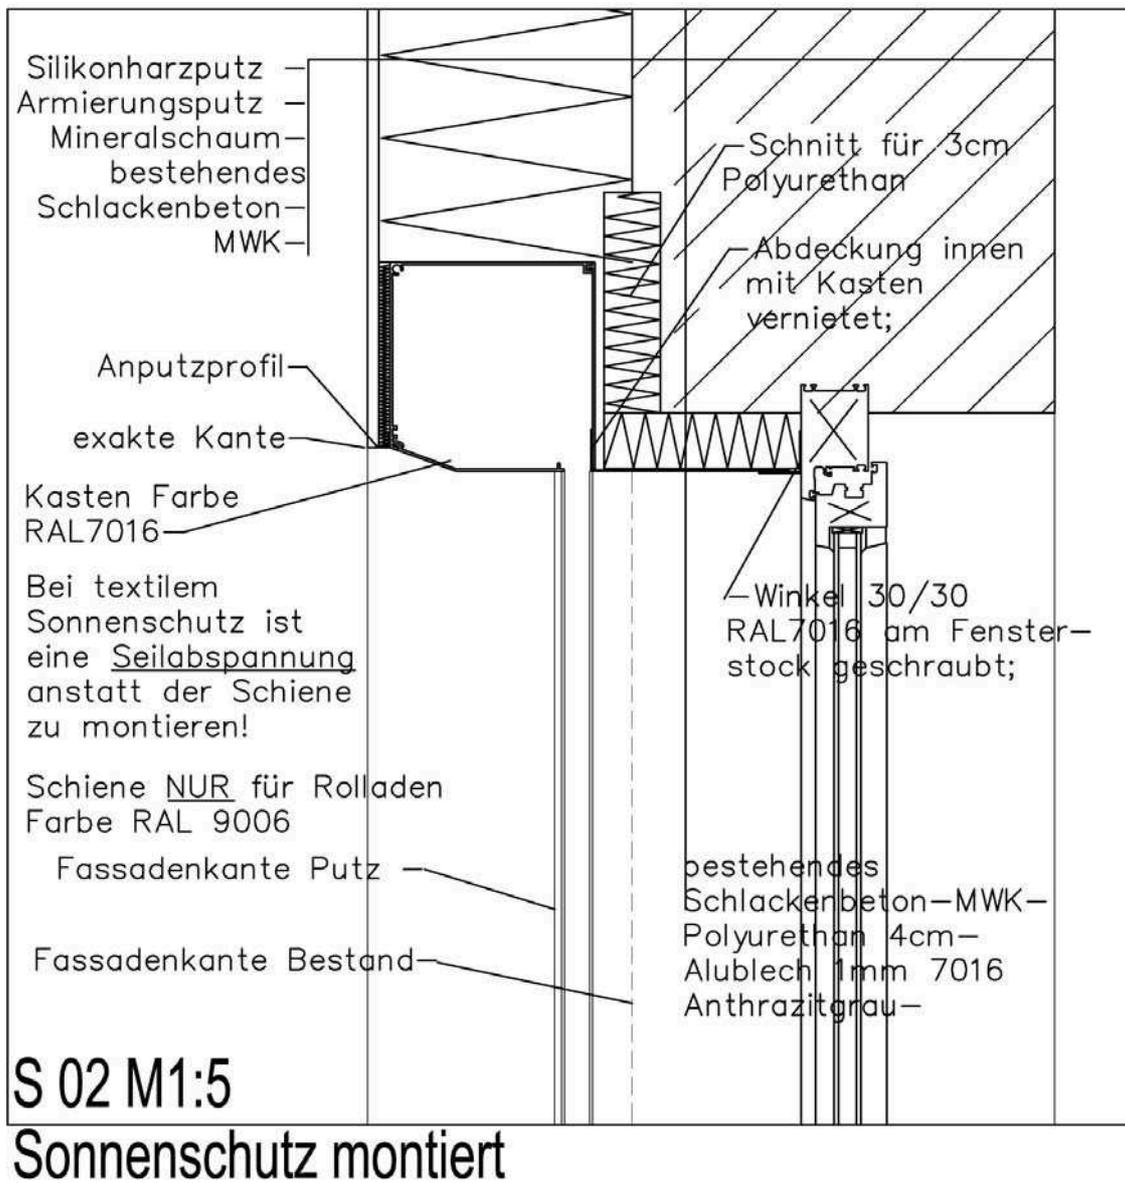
Detail S 02 Vertikaler oberer Fensteranschluss
